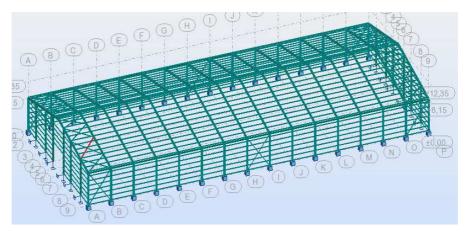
La diagonale la plus sollicité de la poutre au vent.
